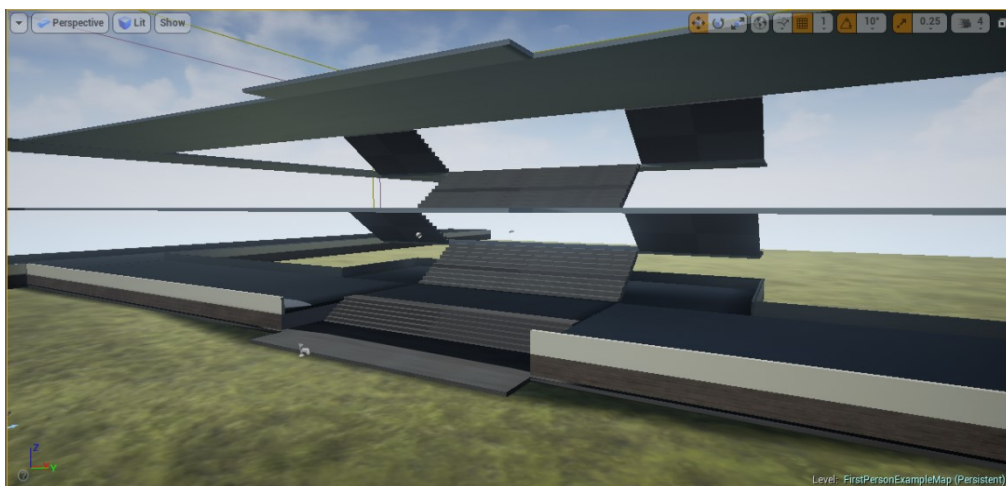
Поэтажные перекрытия с добавлением лестниц.
